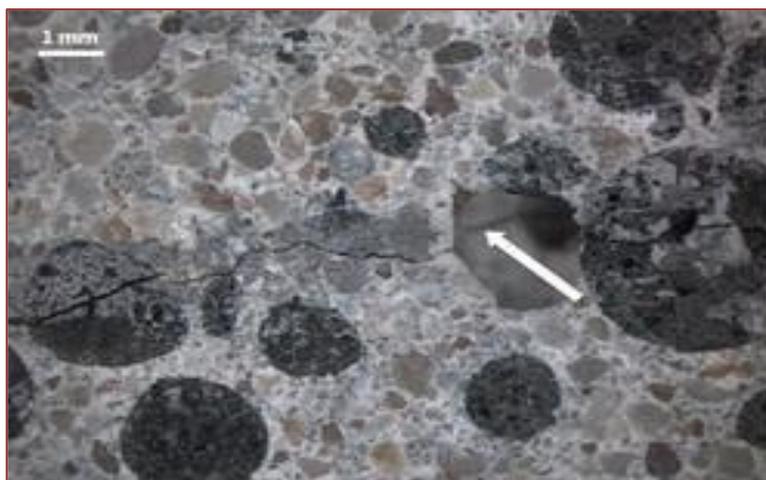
Rachadura apresentada na parede de concreto de um edifício
